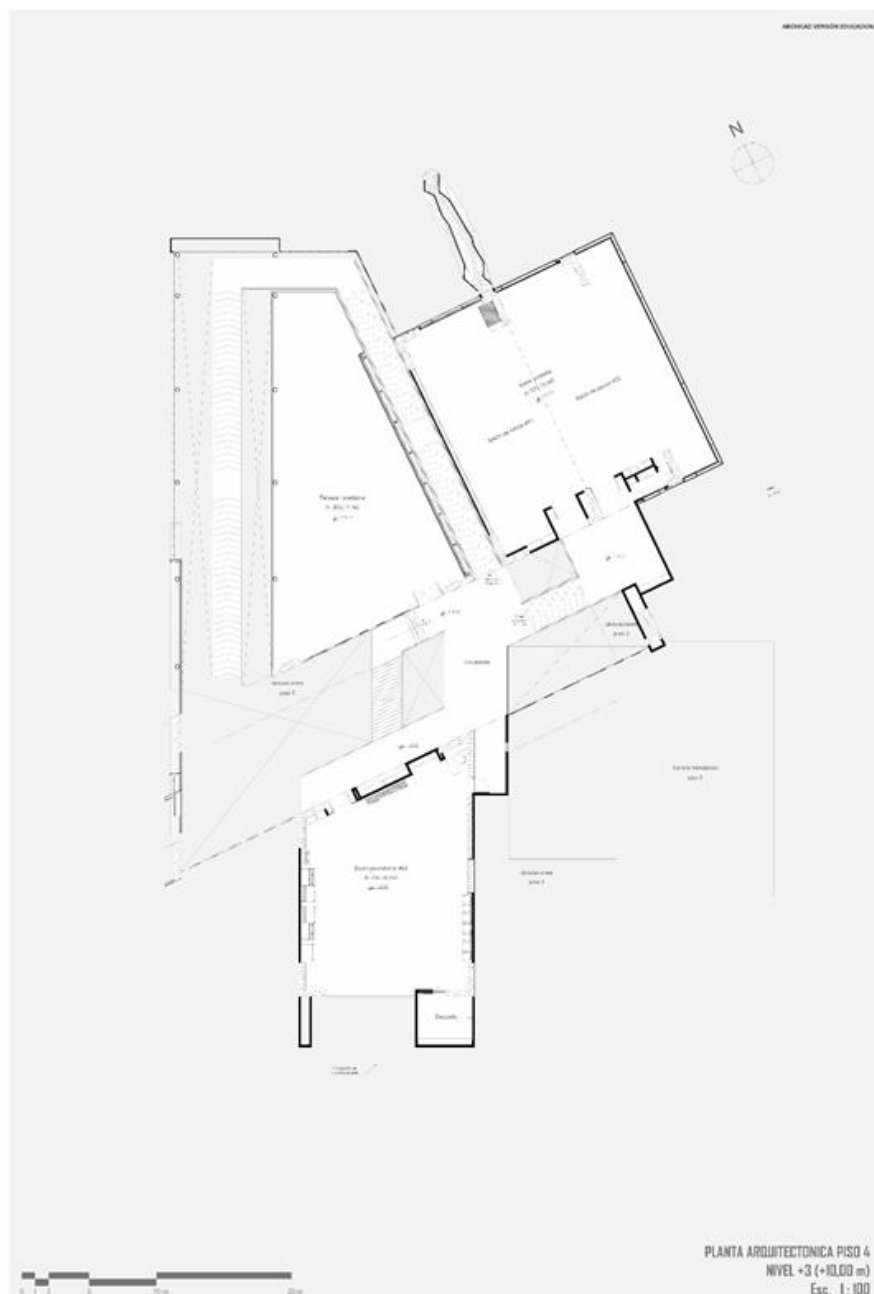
Planta piso 4. Nivel +3 (+10.00m y + 10.50m)
